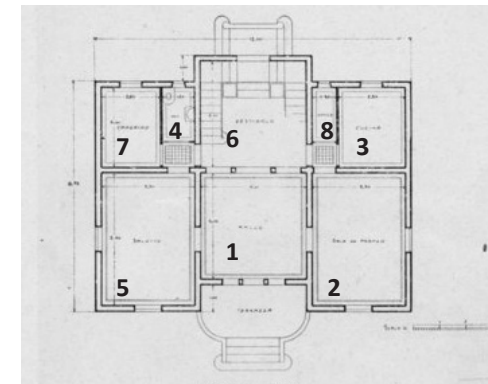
ALZADO FIG.1.4.2 PLANTA BAJA
